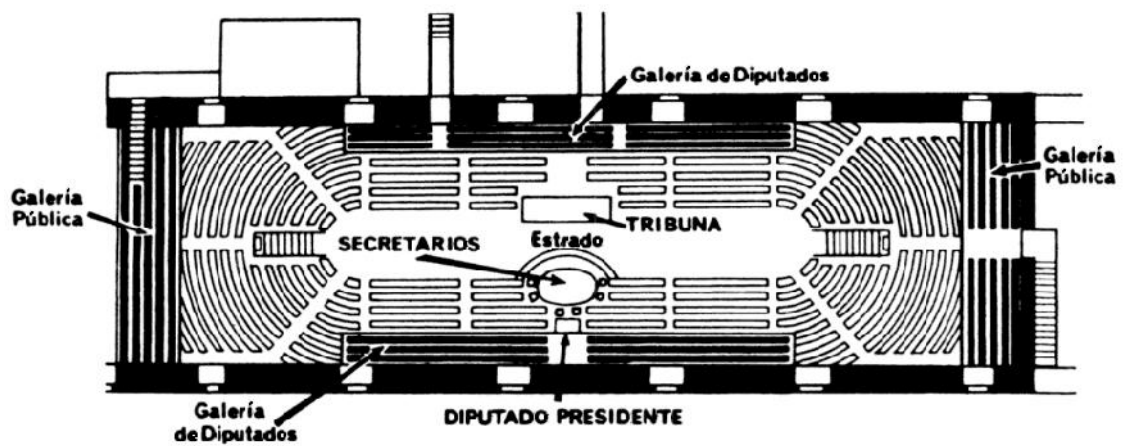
Plano de planta de la sala del picadero [*salle du manège*].
